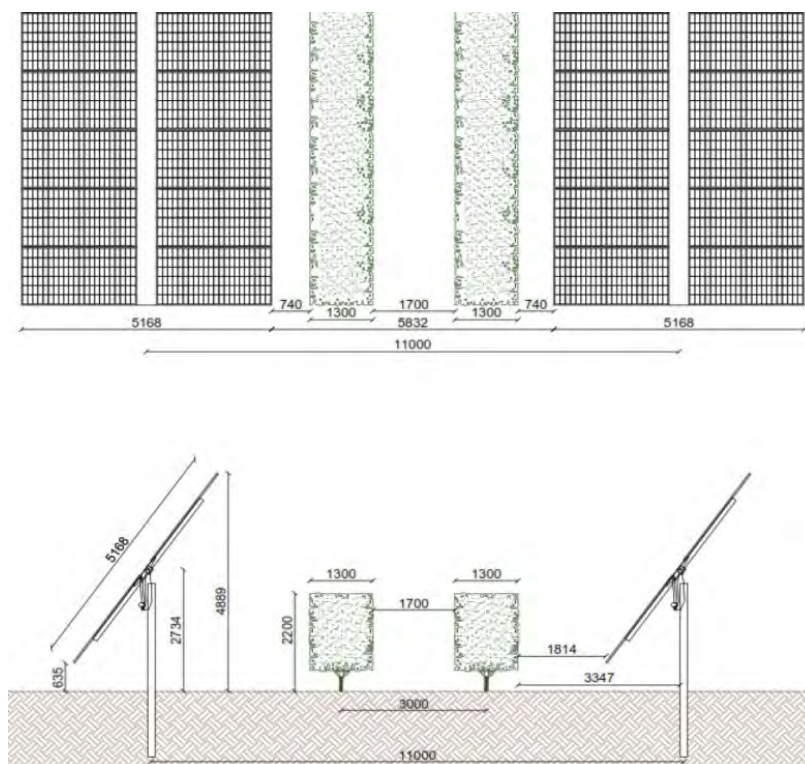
Sezione tipo dell'assetto agrivoltaico
